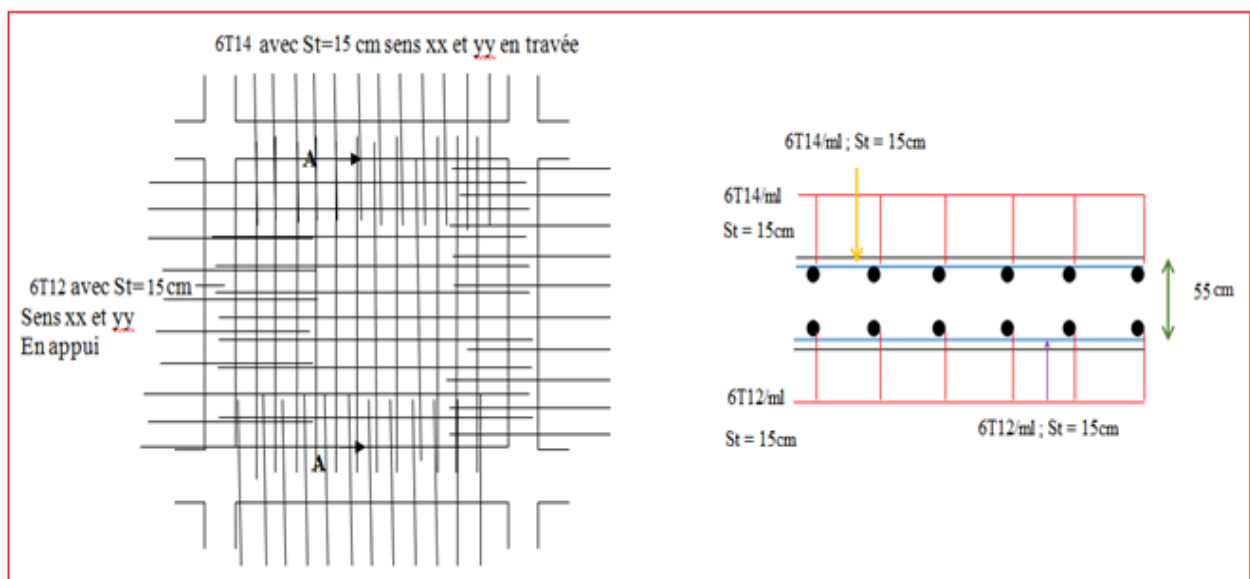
Ferrailage de la dalle du radier pour une bande de 1m sens x-x et y-y
